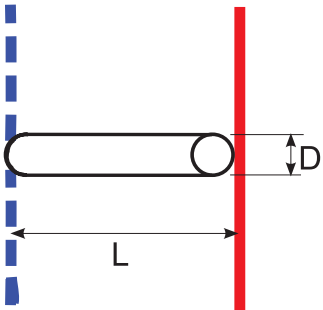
Bypass Detailansicht (→ [1] [IDUS B Abb. 28 und 29])
